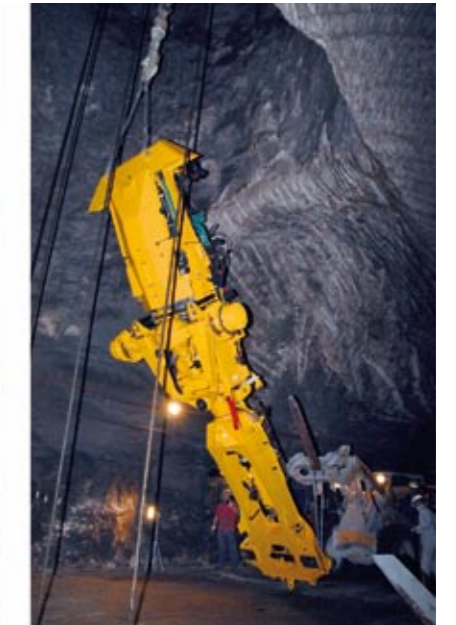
+ 6: Einhängen einer Muldenhälfte und des Dumperrahmens im Schacht Kolenfeld / Shaft transport of the body halves and the machine frame in the shaft Kolenfeld
